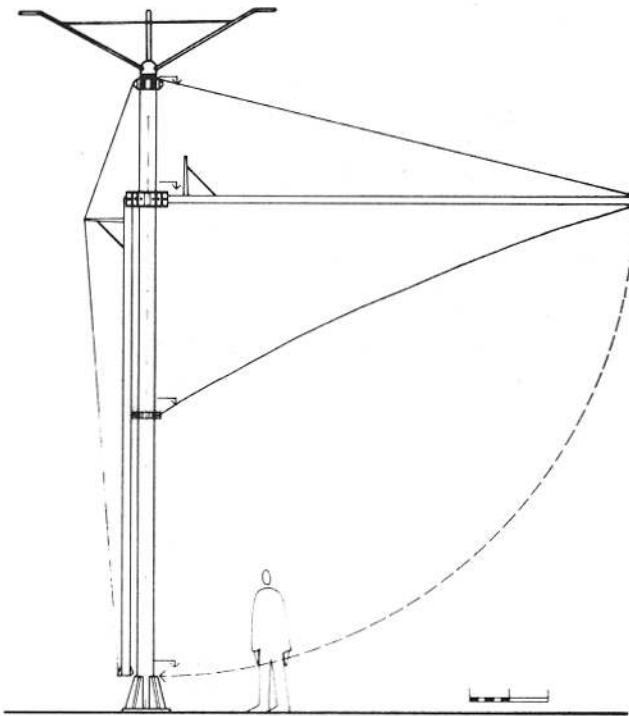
ELEVACION DE CUBIERTA TIPO PARAGUA
